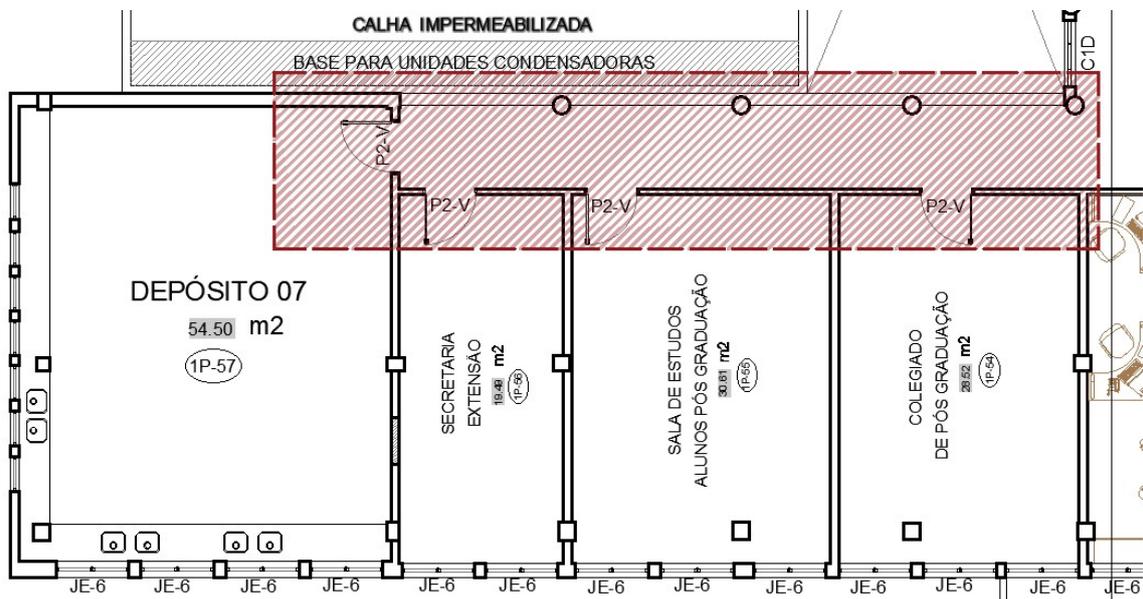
Plata Baixa do Primeiro Pavimento – Corredor de Circulação;
